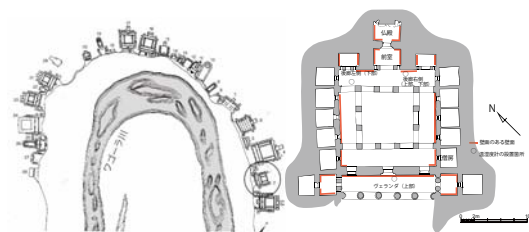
アジャンター石窟配置図(左)と第2窟の平面図(○は温湿度計測箇所)(右)
